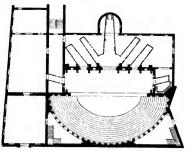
Palladio's Teatro olimpico zu Vicenza. Grundriss. (Nach Gurlitt.)
